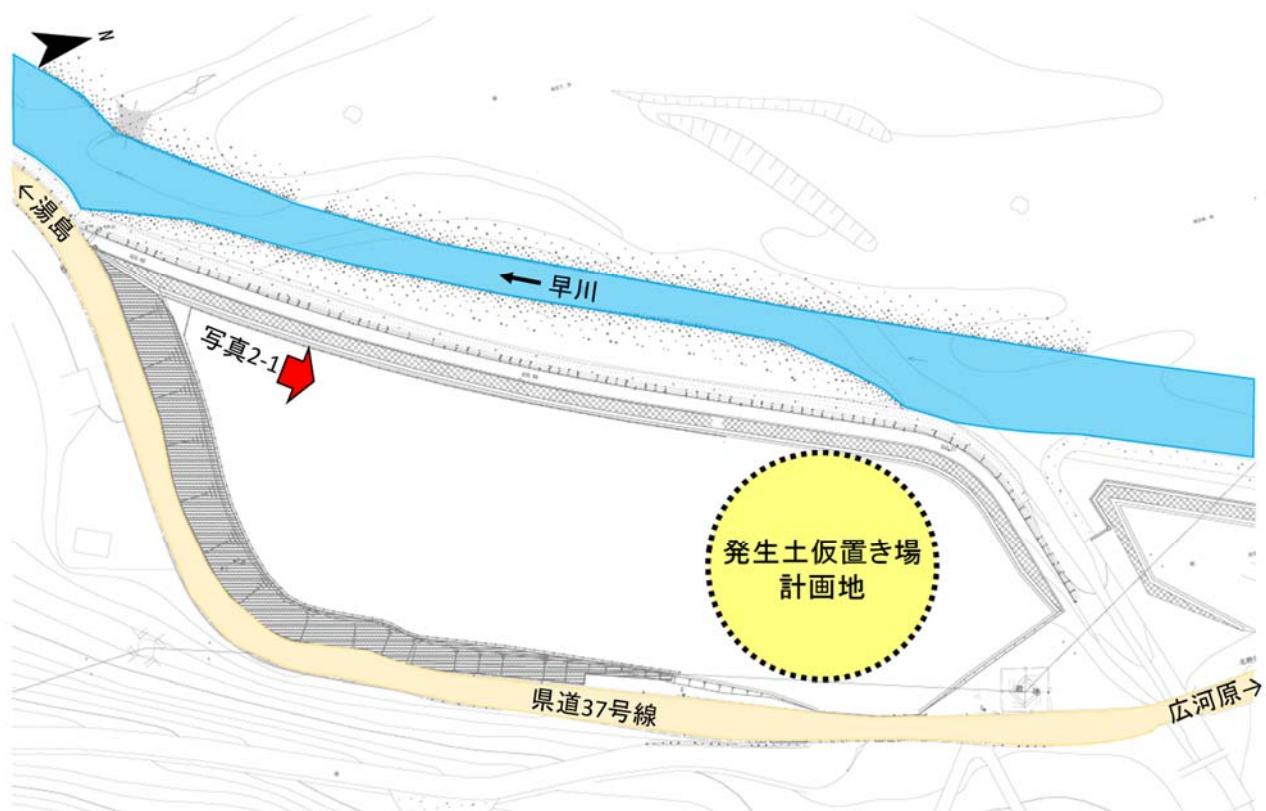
奈良田地区発生土仮置き場計画地平面図（現況）
